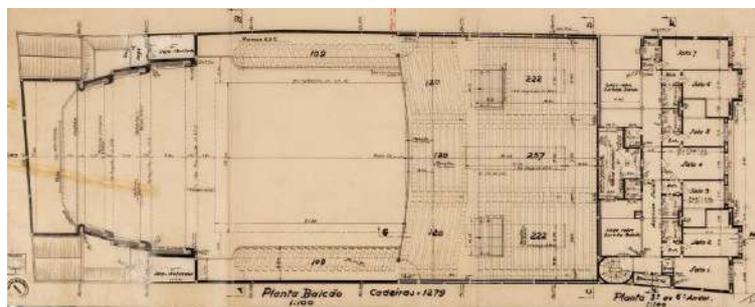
Planta baixa do balcão do Ufa-Palácio.
